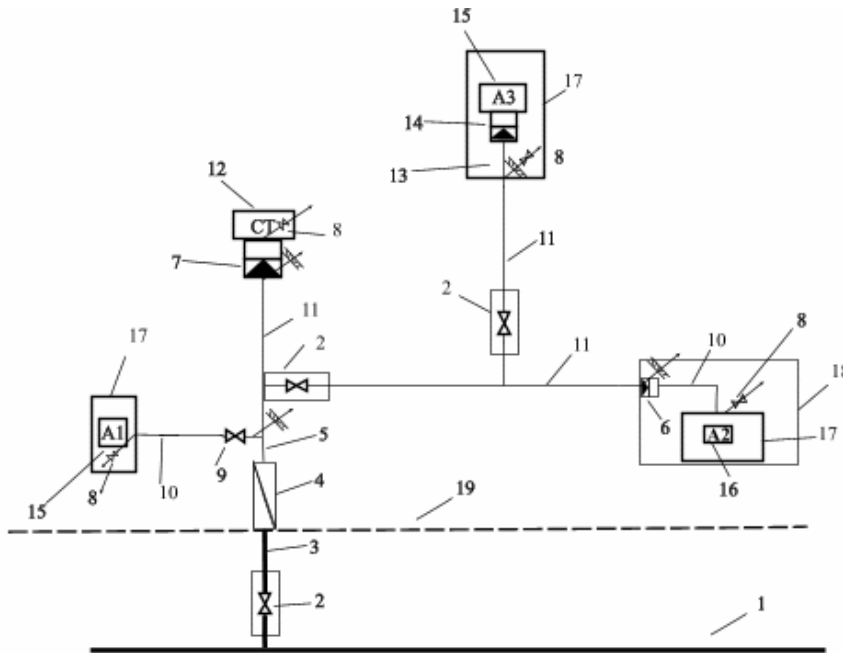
Schema de principiu a unei instalații de utilizare industrială a gazelor
